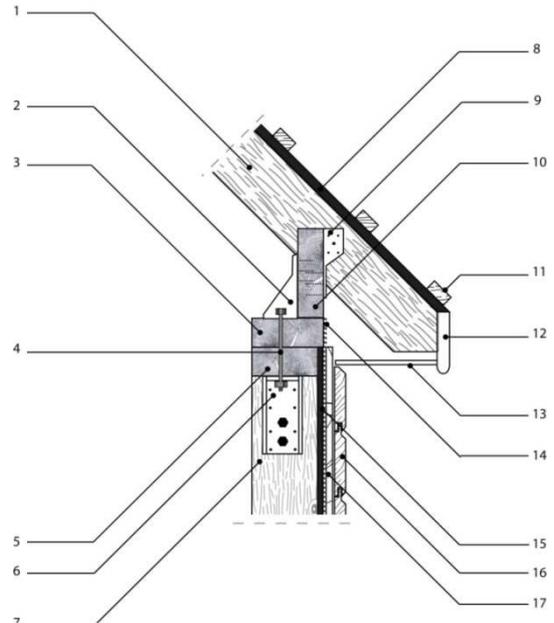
Schémas liaison chevron /traverse haute sans plancher (dans le cas d'un contreventement VT)
